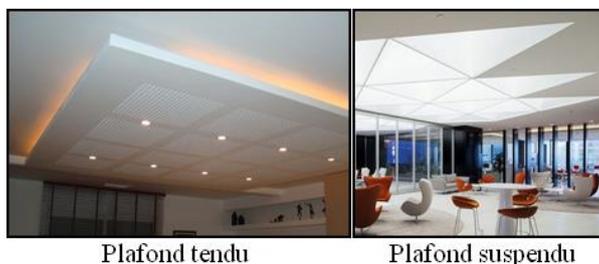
Plafond suspendu et plafond tendu<sup>249</sup>
